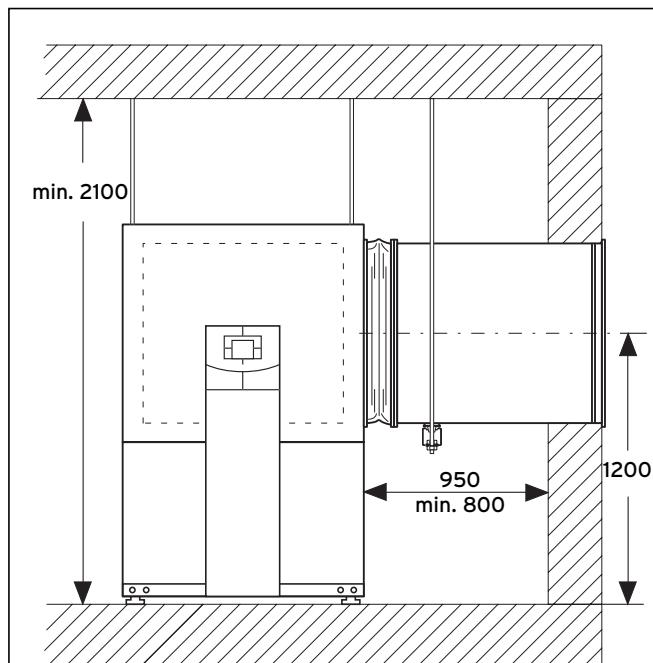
Conduits d'air rigides - vue d'en haut
